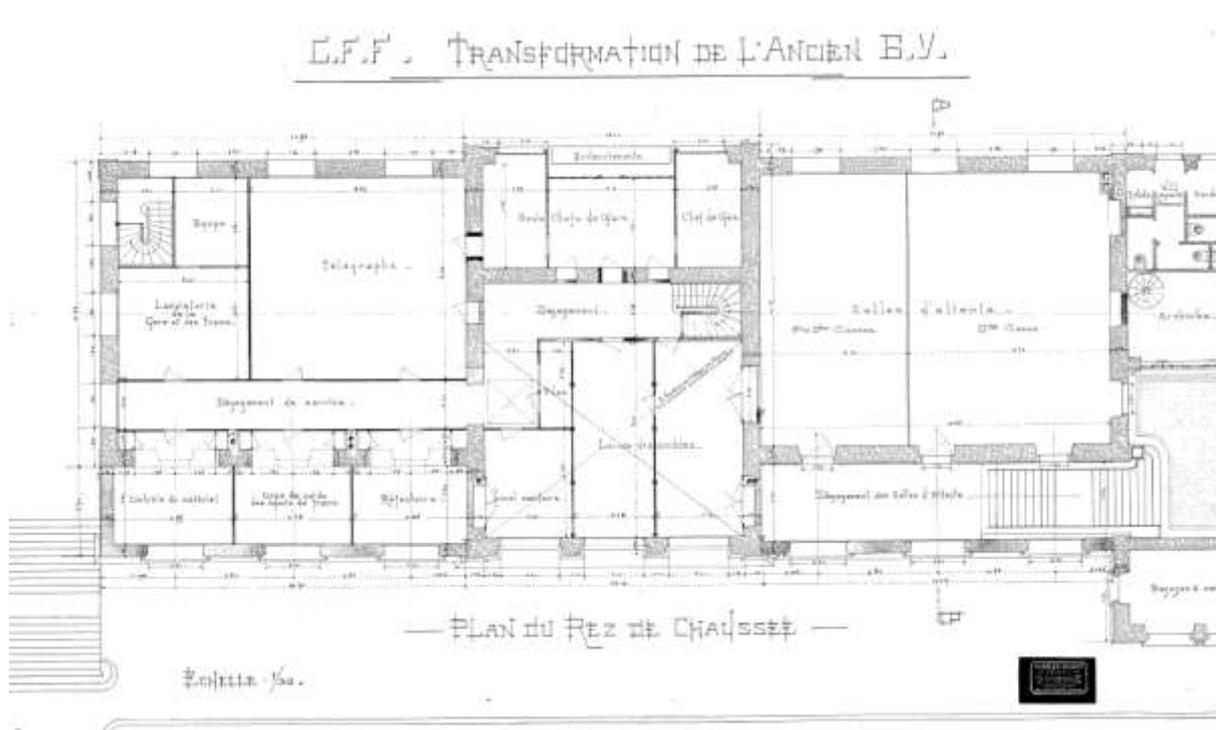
Gare de 1861, plan du rez-de-chaussée, Charles Coigny architecte, 10.8.1909 (CFF Immobilier, SBB-IM-WEST 18000/101).
